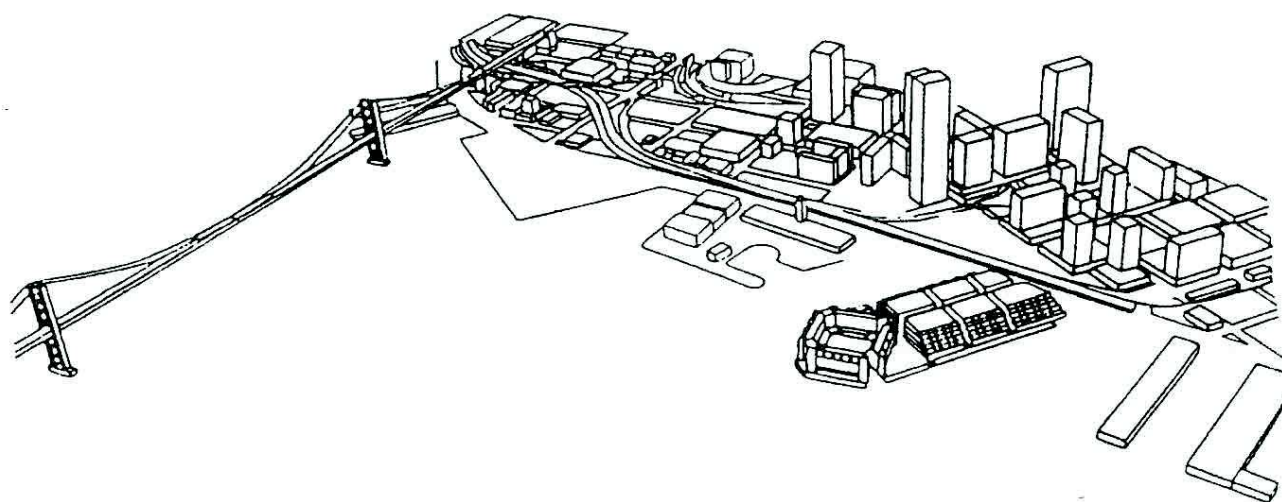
Imagen de espacio exterior (vista a vuelo de pájaro), proyección con planos de proyección inclinado
